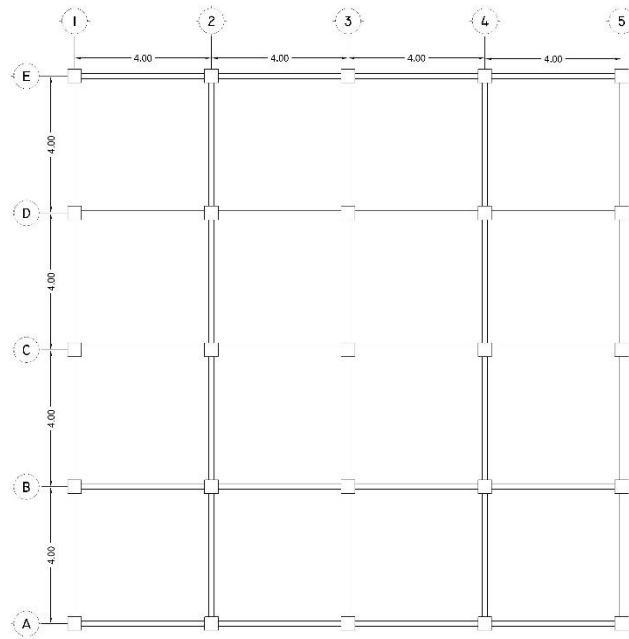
Penulangan Balok Lantai 1 Sampai 5
